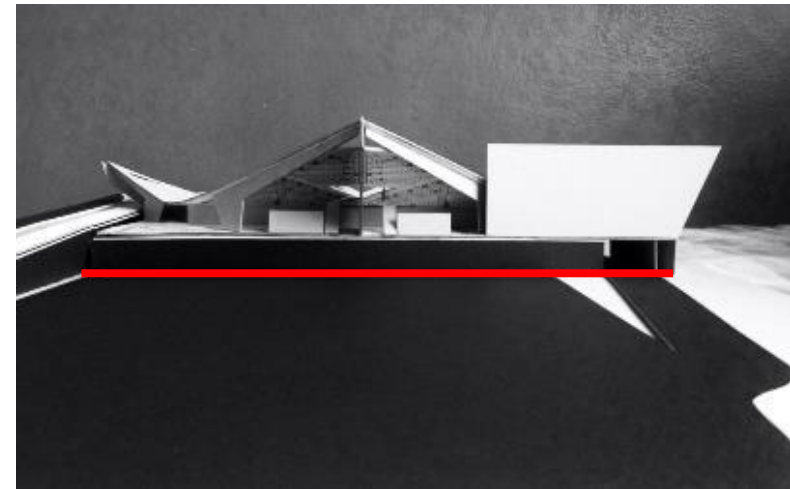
, Corte longitudinal del terreno e implantación de estructura primaria.
